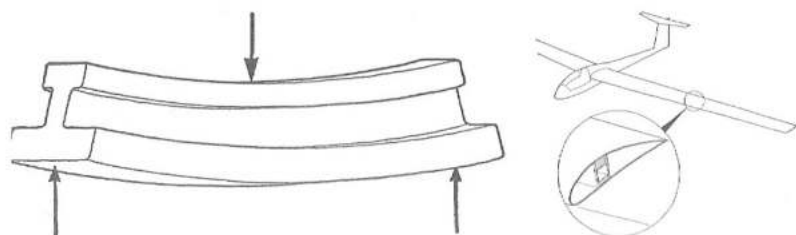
(izquierda) Las vigas de hierro colado tienen más gruesa el ala a tracción que el ala a compresión, debido a que el hierro colado es más débil a tracción.
